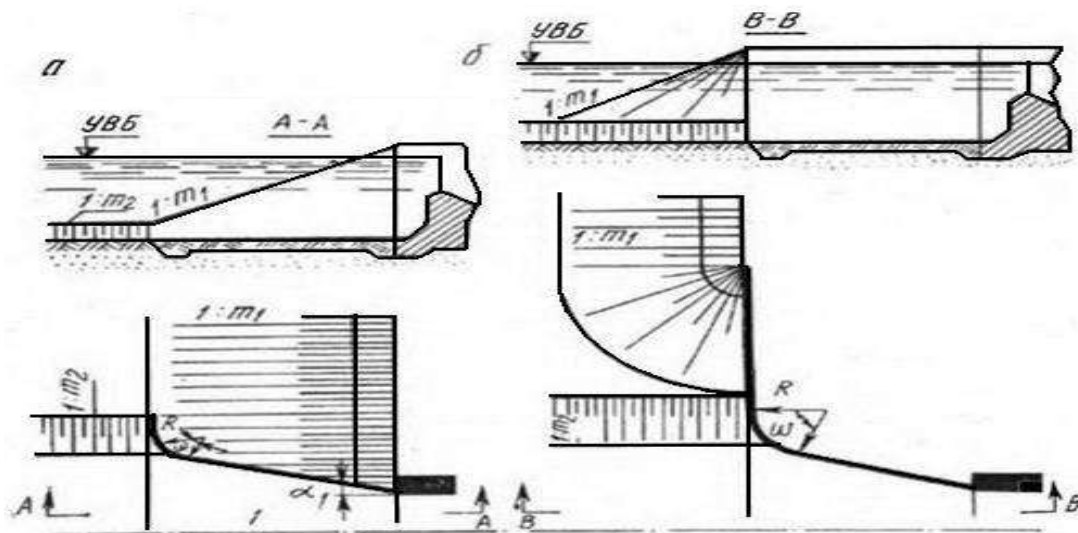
Схема сопряжения бетонных и земляных сооружений: а - по типу ныряющей стенки; б - по типу обратной стенки
